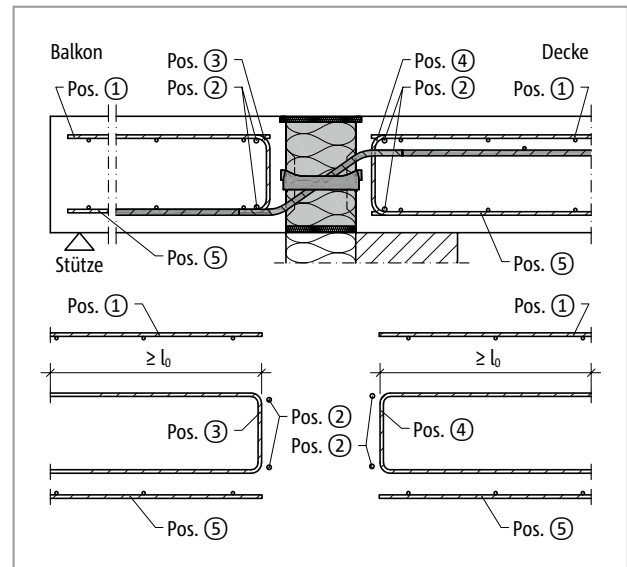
Schöck Isokorb® XT Typ Q-V5 bis Q-V11: Bauseitige Bewehrung
